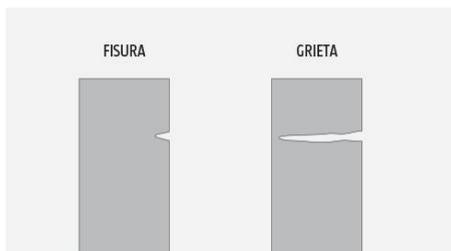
Fisura y grieta. Fuente Wikipedia.
